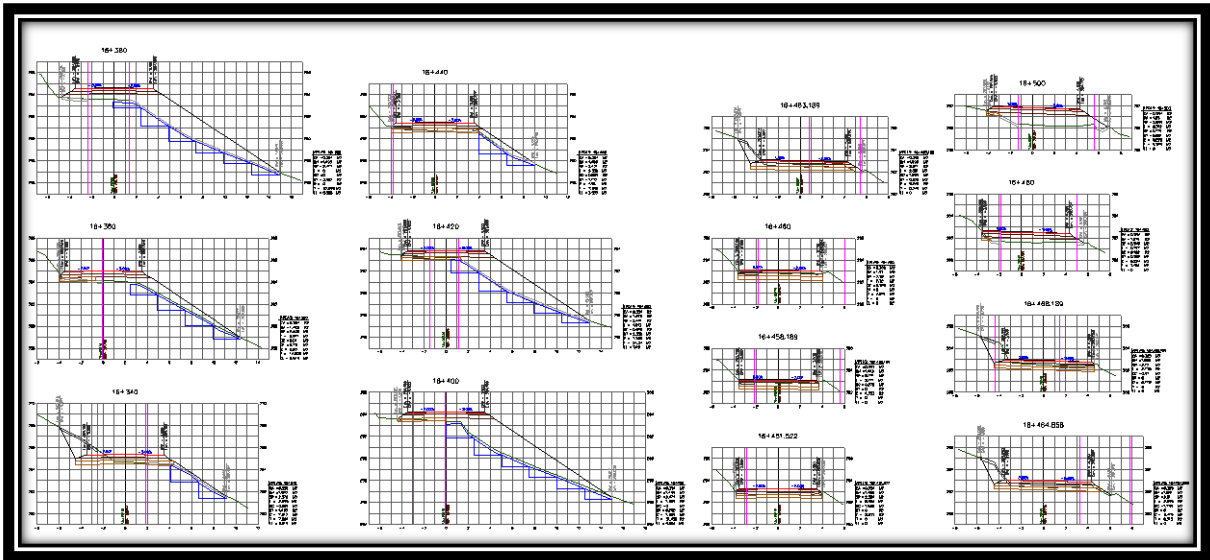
Secciones de construcción del km 16+340.000 al km 16+500.000.
